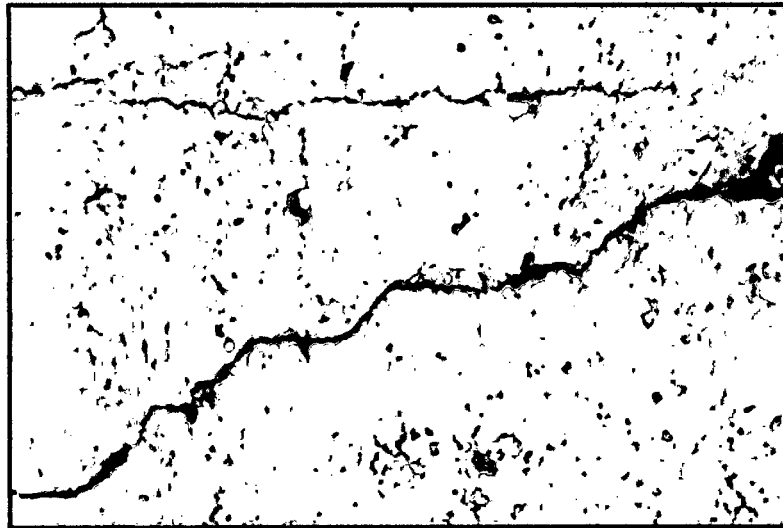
Grieta primaria y secundaria por tensión en el concreto
